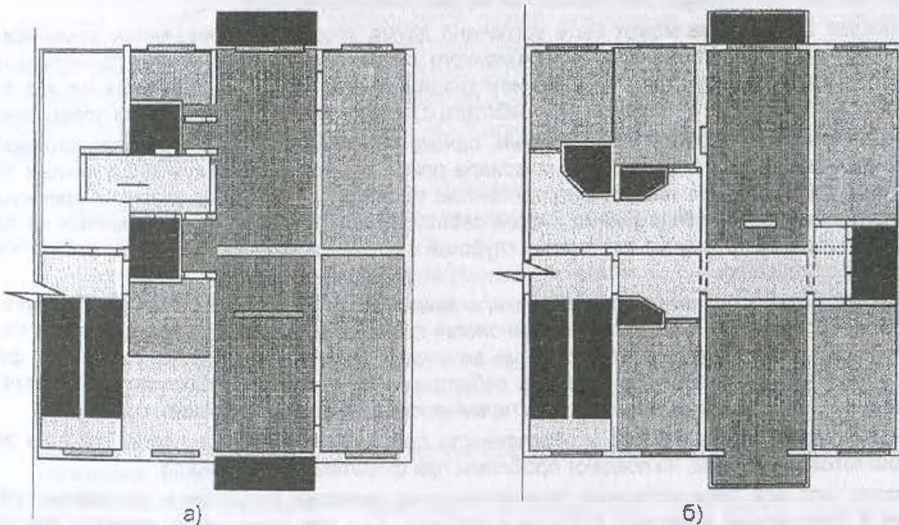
Фрагмент торцевой секции жилого пятиэтажного здания серии 1-464:
